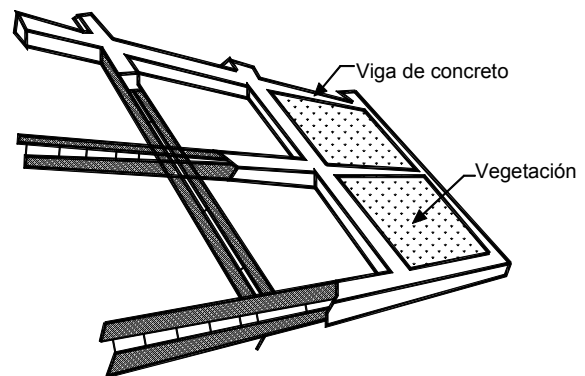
Vigas de concreto armado como confinamiento de la vegetación.
